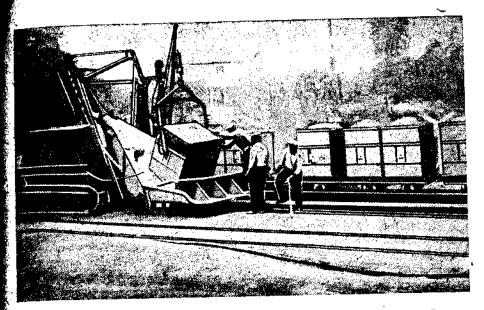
Подача материалов к бетономещалке поездом вагонеток, с выгрузкой вагонеток в ковщ поворотным краном бетономещалки.
